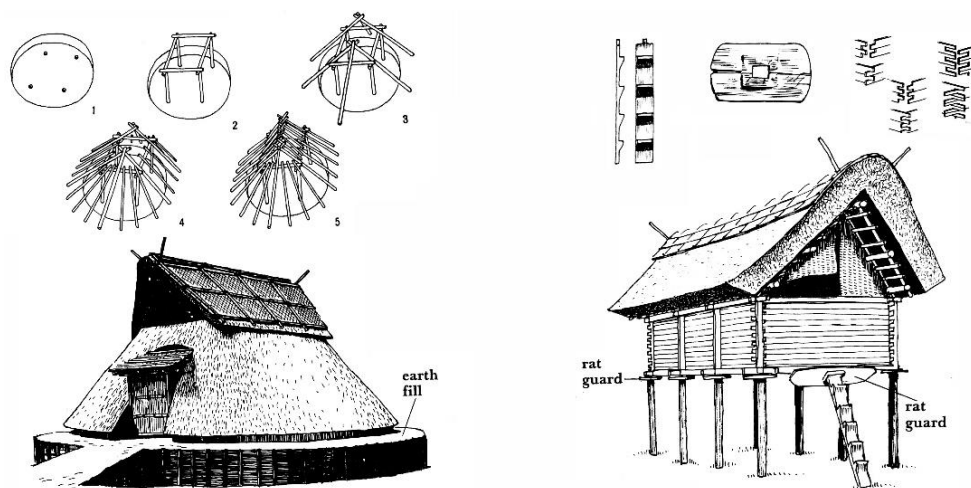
Abrigo escavado Yayoi com esquema conjectural e Espigueiro elevado Yayoi com detalhes (Hozumi, 1985).
